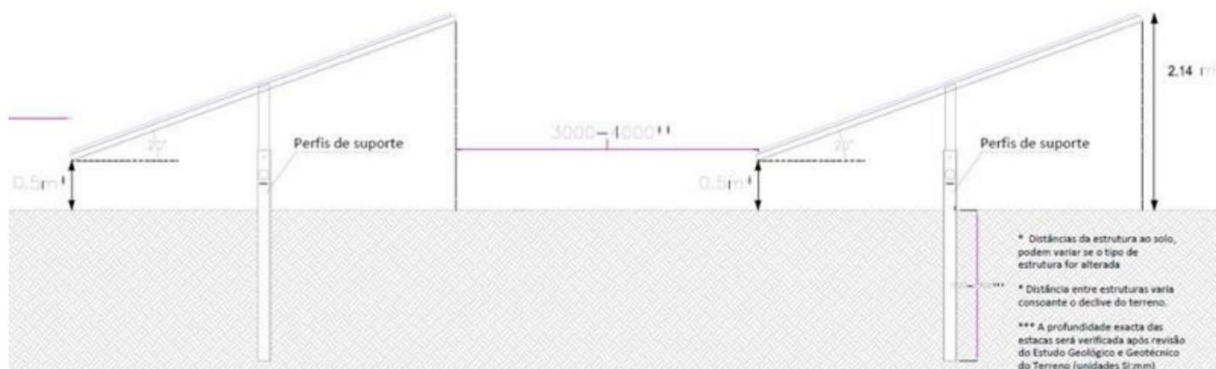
Estrutura tipo proposta. (Fonte: PDA).
